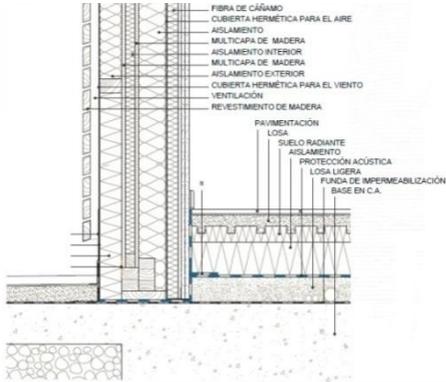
detalle constructivo de forjado en contacto con el terreno
